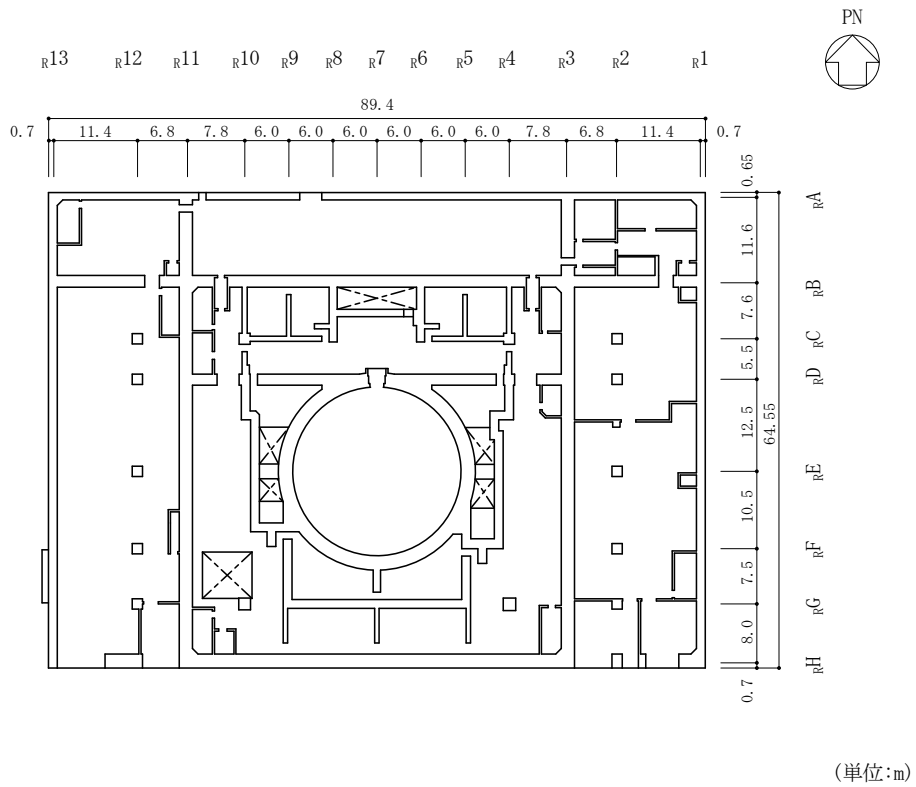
(4) 原子炉建物の概略平面図 (EL 23.8m)
